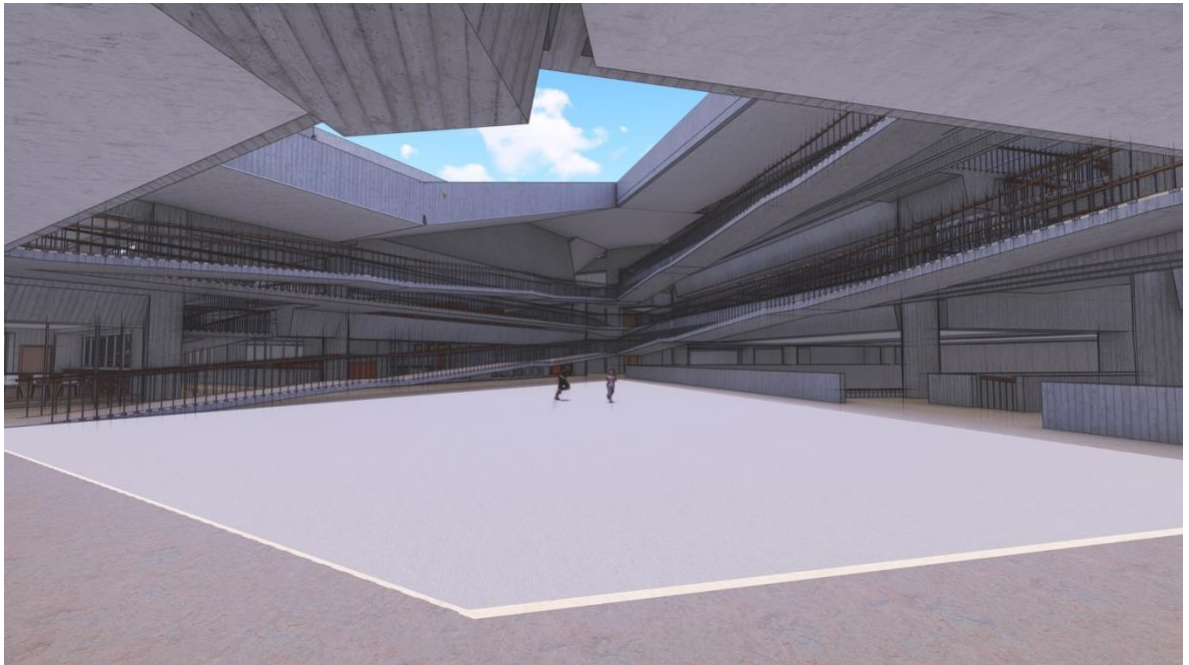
Imagen interior zona central. Fuente: Elaboración propia
